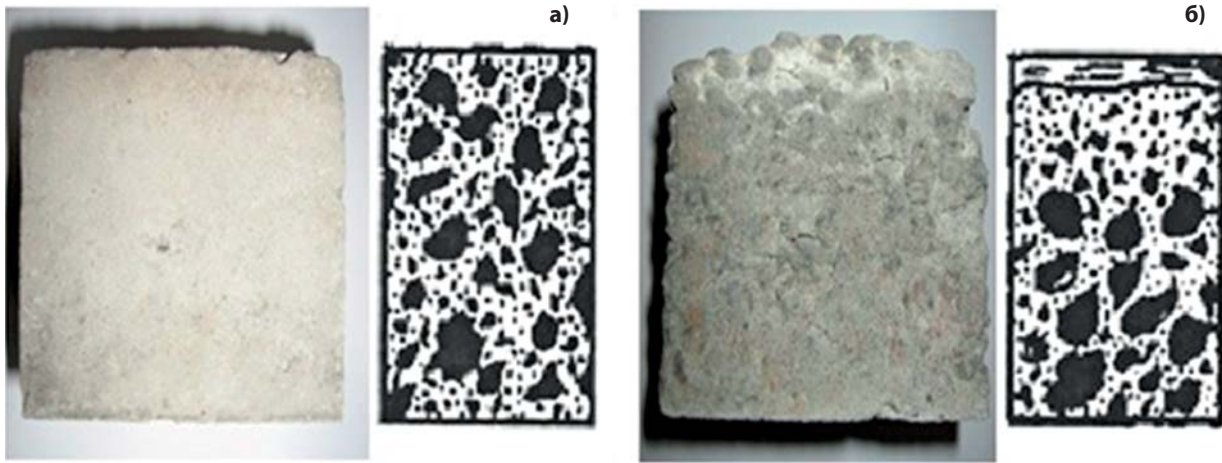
Зразки бетонну (В/Ц=0,26) укладені:
